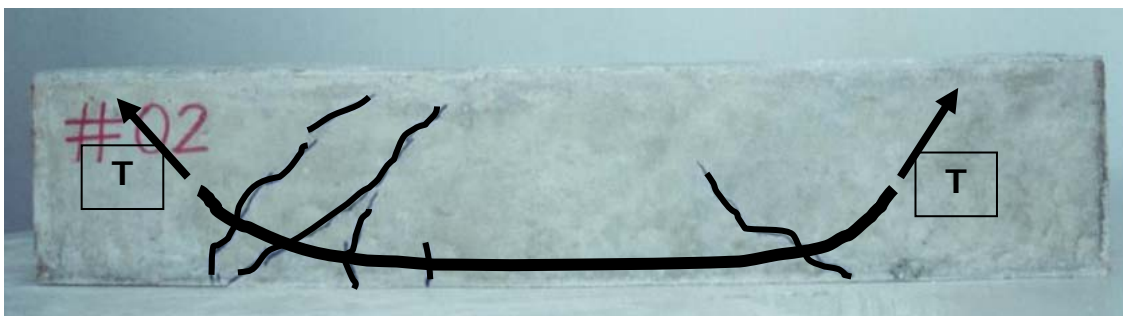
Modelo de ruptura – fissuras inclinadas entre a carga e o apoio
